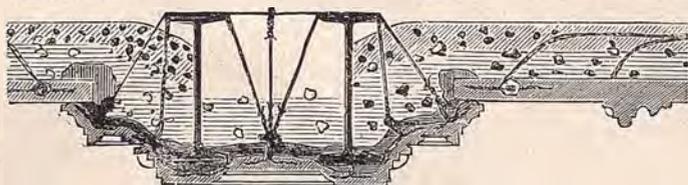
Solaio con travi portanti di ferro, solette di calcestruzzo e finimento del soffitto di gesso.
